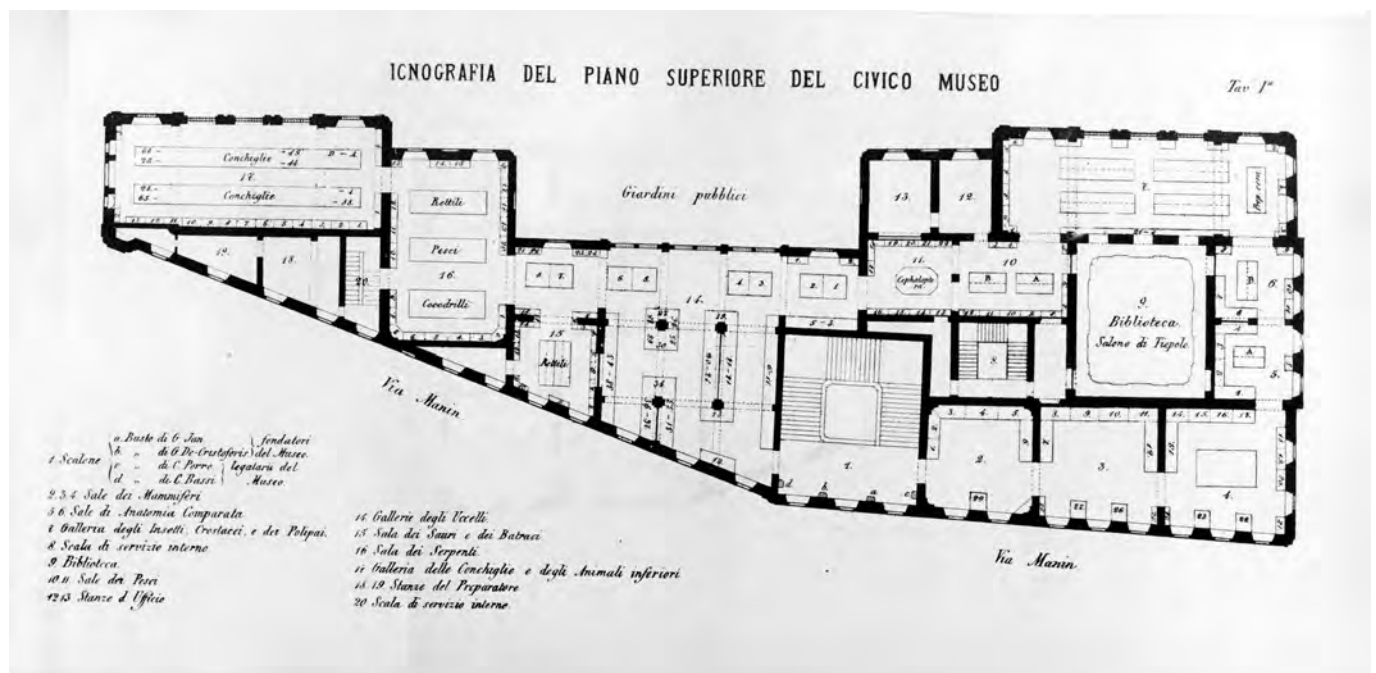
Planimetria del secondo piano del Museo di Storia Naturale nelle sede di Palazzo Dugnani, 1870. / Plan of the second floor of the Museo di Storia Naturale in Palazzo Dugnani, 1870. Archivio fotografico MSNM.
